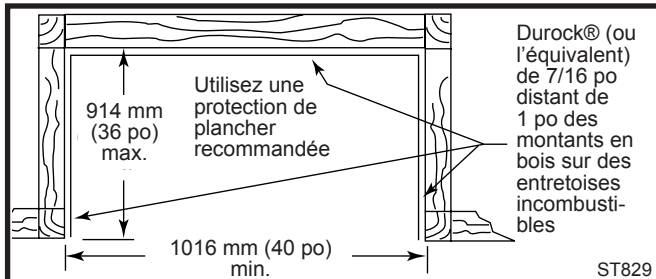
Plan de plancher d'alcove. Le Sheetrock à l'avant vient buter sur le recouvrement de l'alcove en Durock® (ou l'équivalent).
